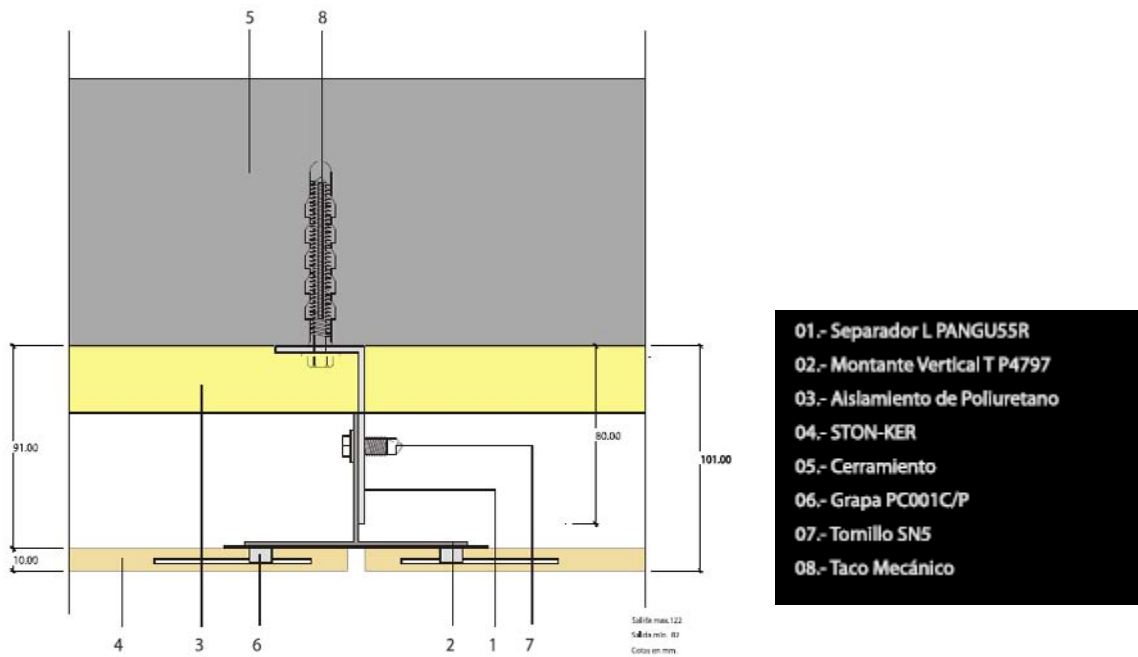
Detalle constructivo del catalogo STON-KER (Poreclanosa), sección vertical
